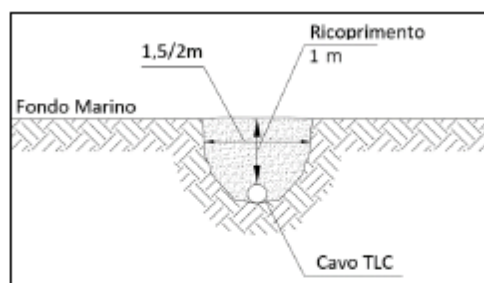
Tipica Sezione Trasversale di Cavo affossato
